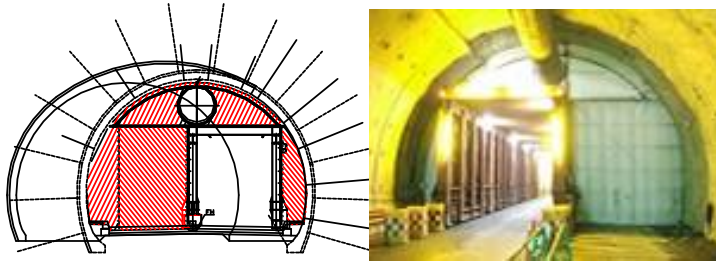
移動式隔壁構造断面図 写真-1 移動式隔壁
